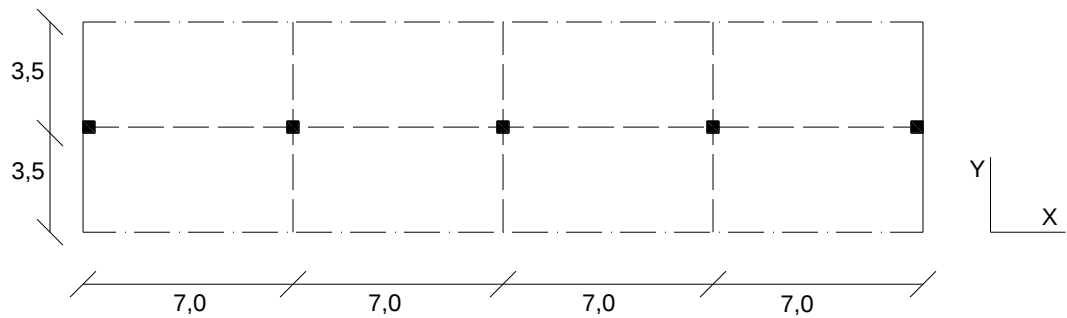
Disposição em planta do pórtico utilizado para avaliação das cargas verticais
